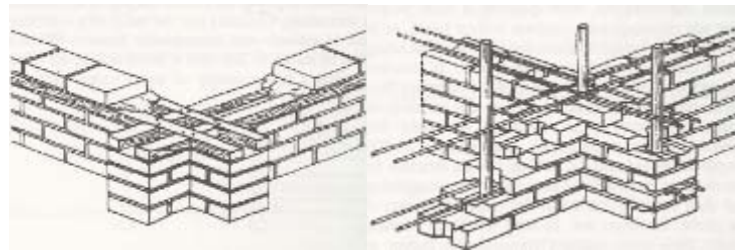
Arriostramiento de los muros. Fuente: (Houben & Guillaud, 2008).
